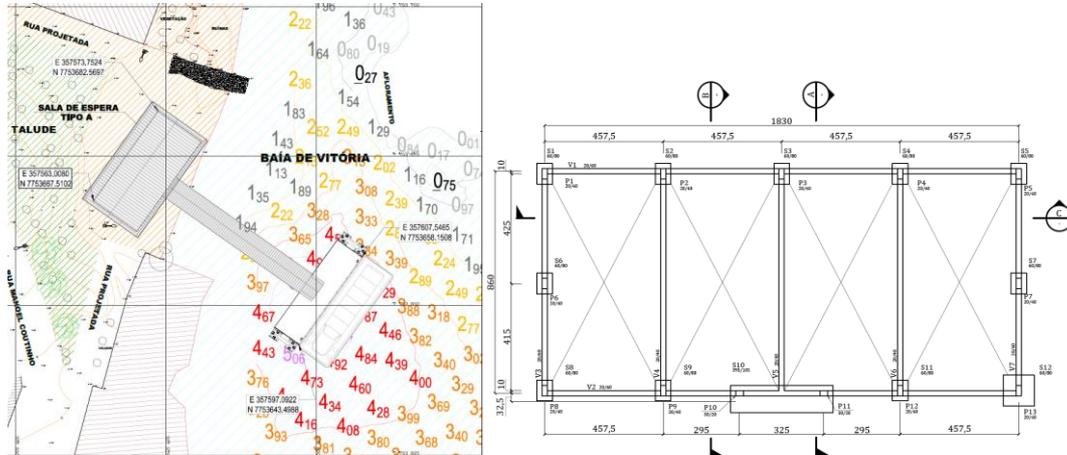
Implantação das estruturas em Porto de Santana/Cariacica e projeto de fundação direta
